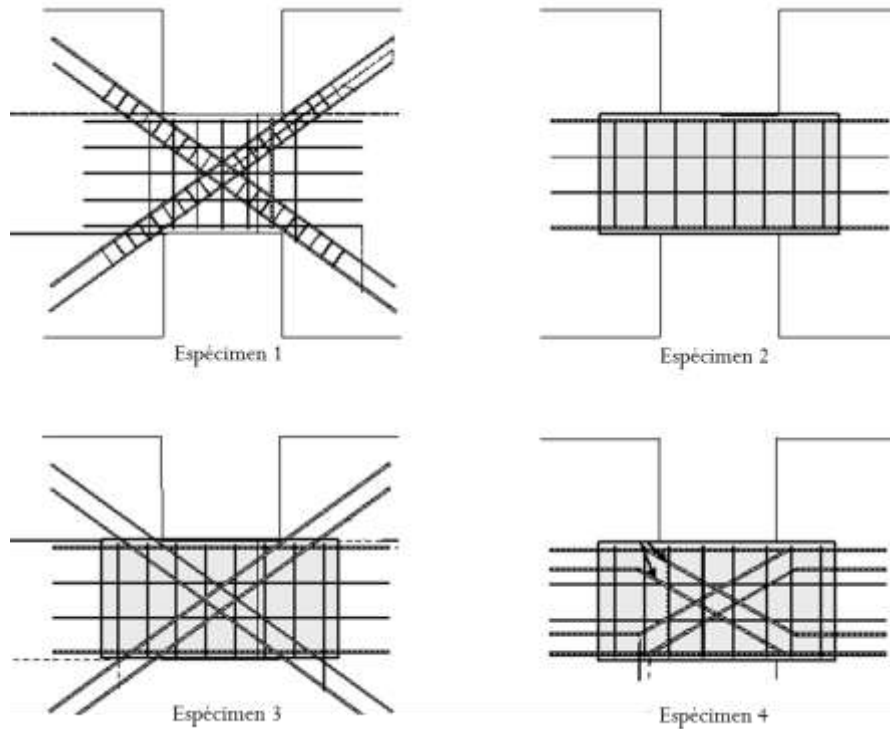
Esquema de armado de vigas (Estudio en Michigan EEUU)
